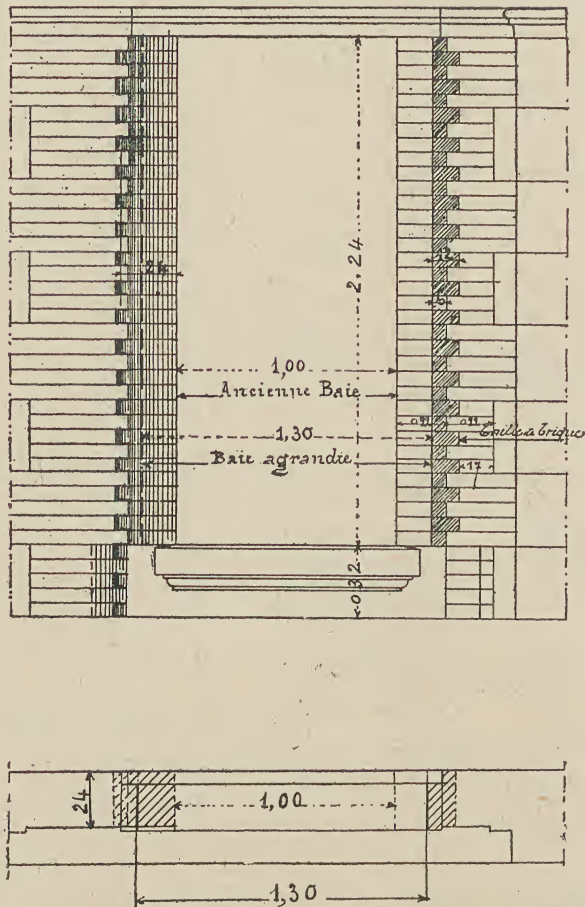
3^e étage : petit salon, plan et élévation de la baie transformée dans la brique apparente.
